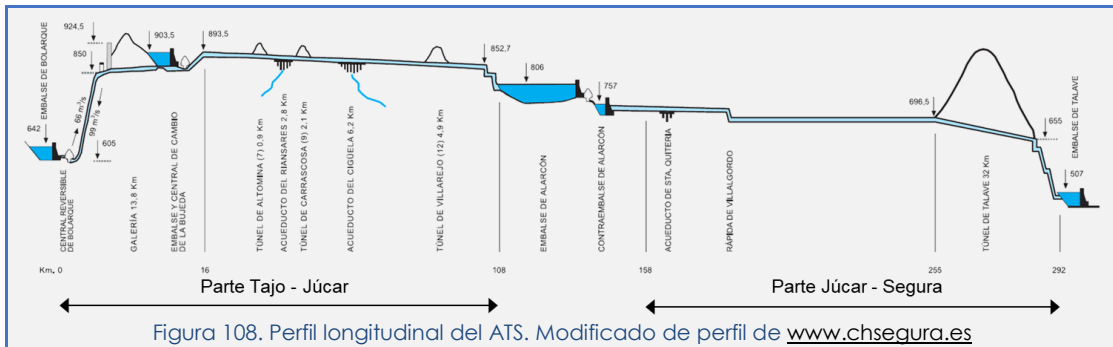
Perfil longitudinal del ATS. Modificado de perfil de www.chsegura.es
